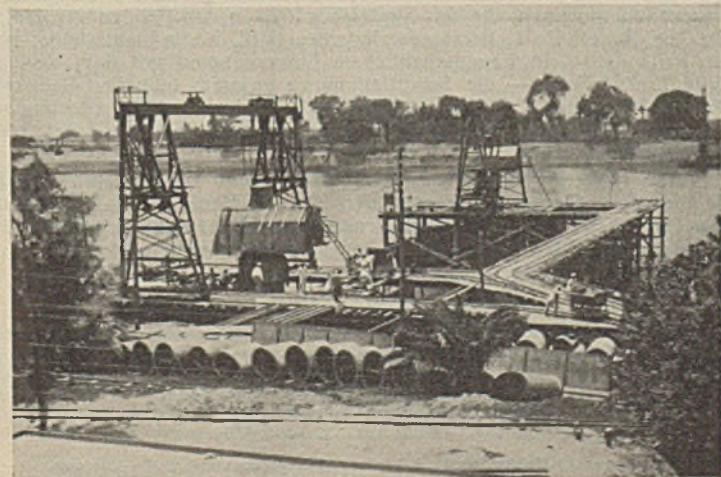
Baujahr 1931: ein Widerlager und Pfeiler 4 in Arbeit.
